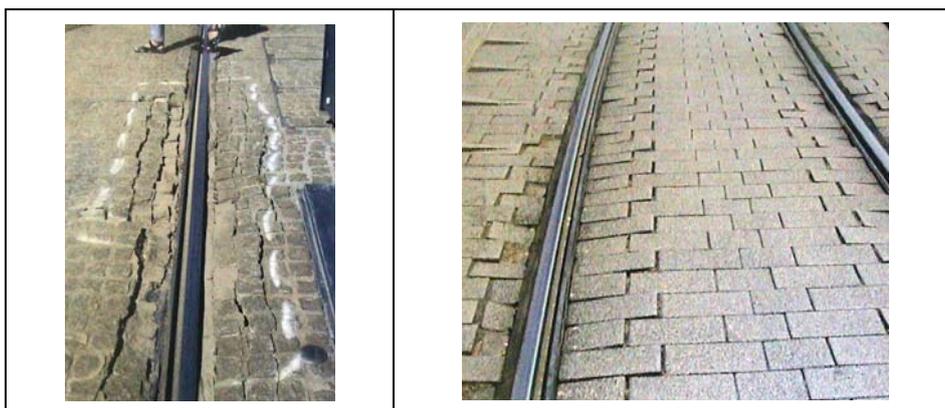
Esempi di cedimento della pavimentazione ai lati del binario [1]
